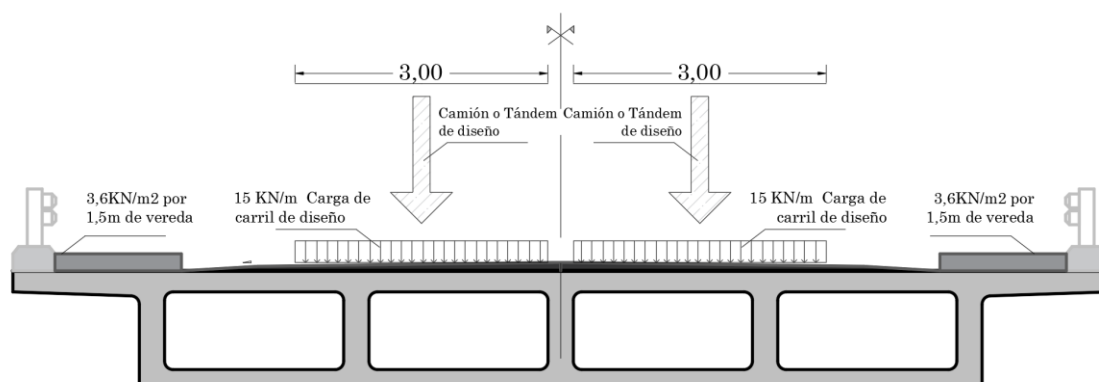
Sección de viga cargada con sobrecargas (Fuente: Elaboración propia).
